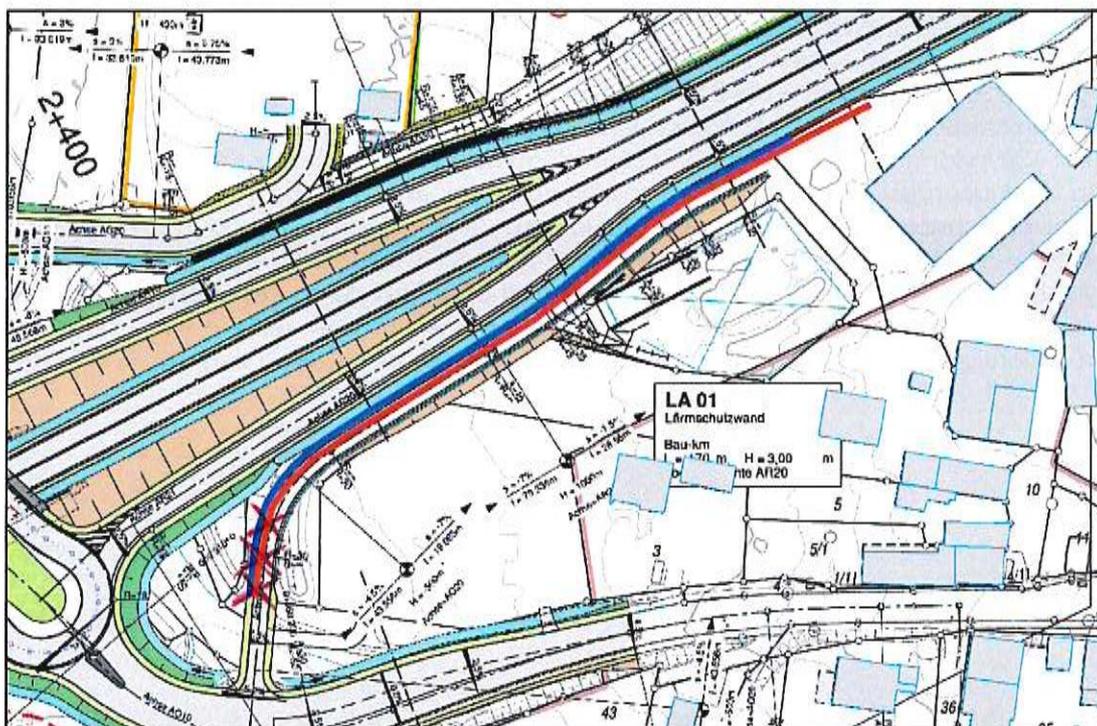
Lageplan mit Kennzeichnung der geplanten Lärmschutzwand (blau)
